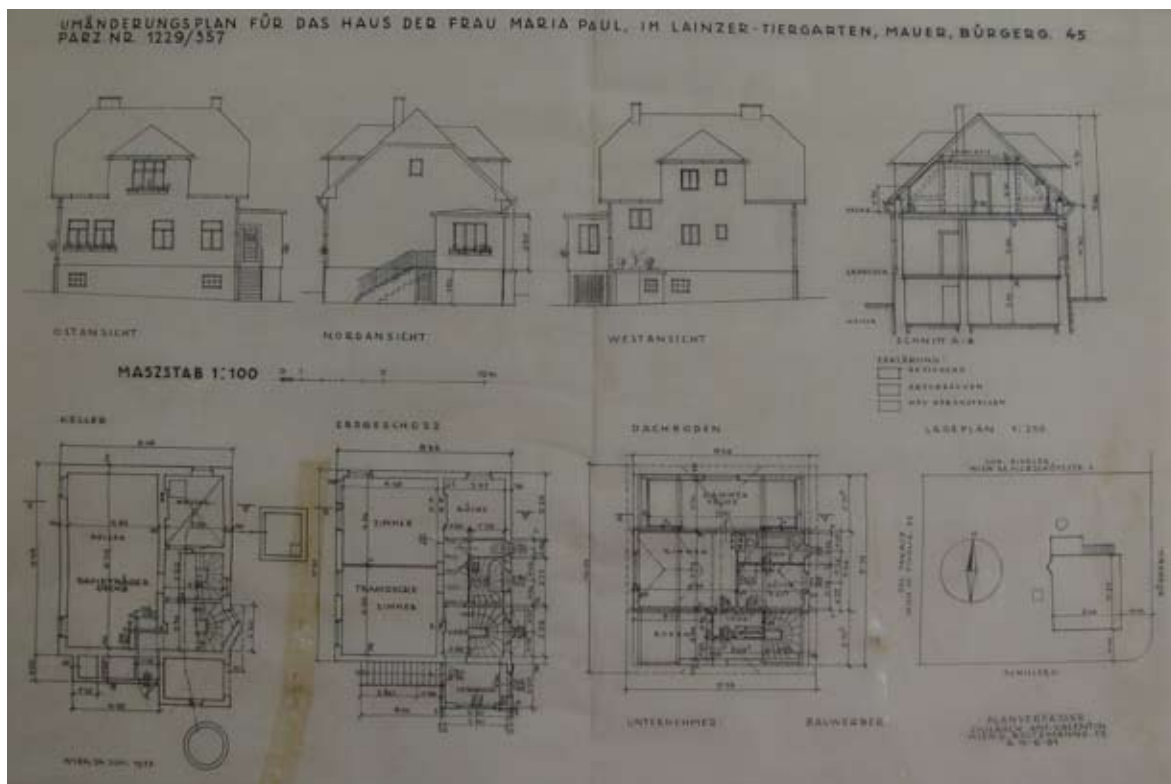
Plan 21.1: Anton Valentin. Umänderungen für das Haus der Frau Maria Paul, im Lainzer Tiergarten, Mauer, Bürgerg. 45. Parz. Nr. 1229/357. Ansichten, Schnitt, Lageplan und Grundrisse. Maßstab 1:100 bzw. 1:250. 24. Juni 1936.
